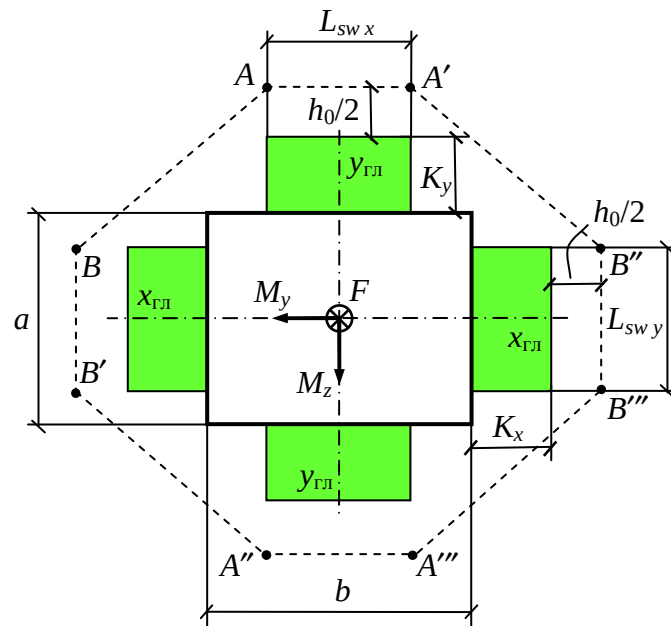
Сечение колонны и расчетный контур продавливания для плиты перекрытия.
